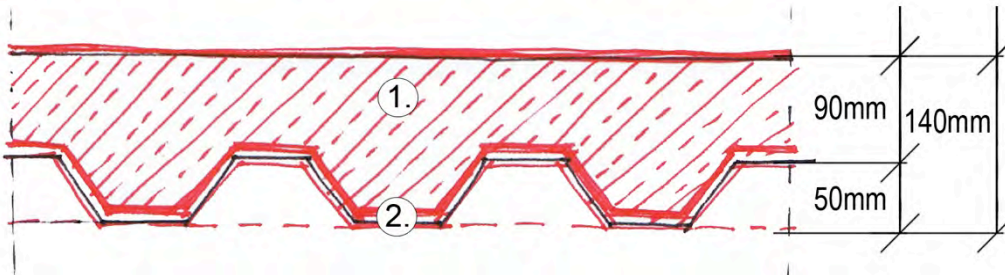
Probenabschnitt Decke Trapezblech 14cm
